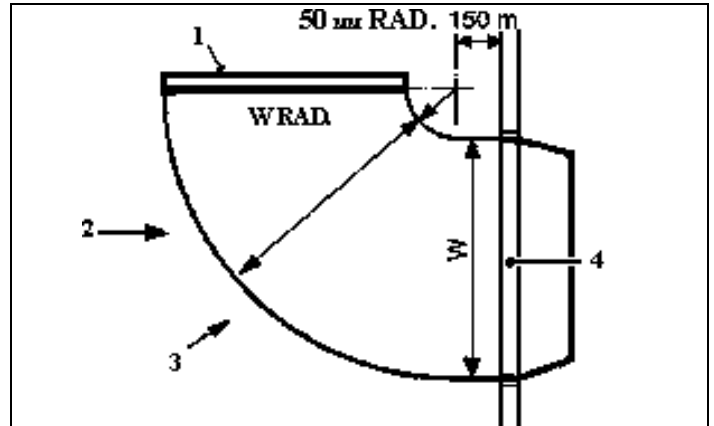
1-жалюзи для отвода горячего воздуха; 2- господствующий ветер; 3- защитный кожух; 4-проем без жалюзи. W-ширина проема.
